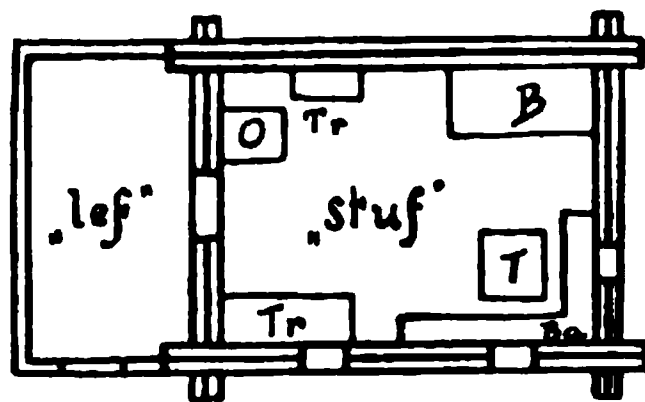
Grundriss zum Häuschen aus Klein-Bistritz.
